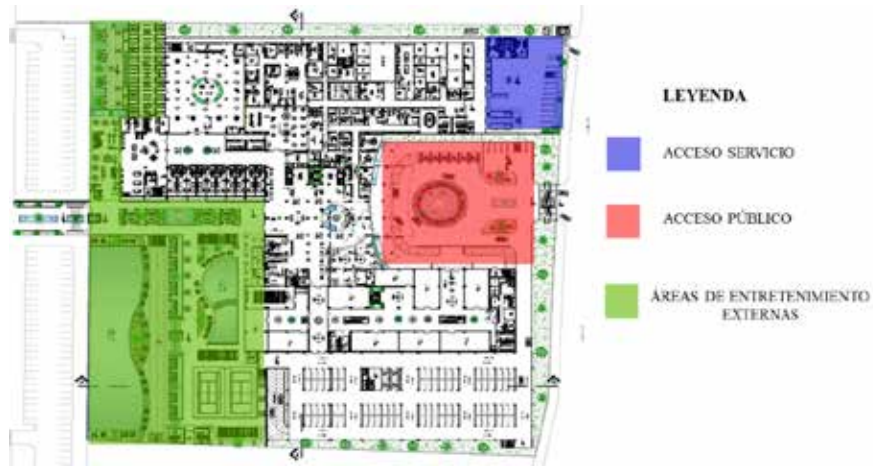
Planta Baja (áreas externas del edificio). (2017).
